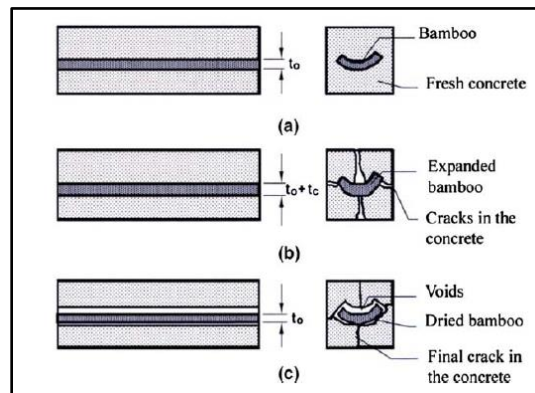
(a) bambú en hormigón fresco, (b) bambú durante el curado del hormigón y (c) bambú después del curado del hormigón. Tomado de Bamboo as Reinforcement in Structural Concrete Elements, por (Ghavami, 2005).
